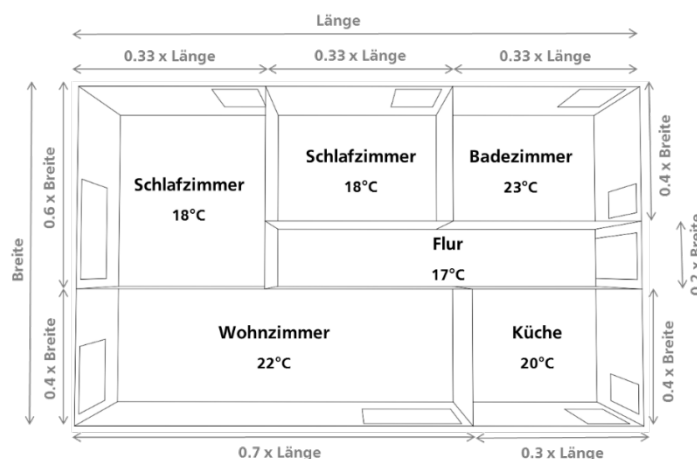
Grundriss für Standard Einfamilienhaus
